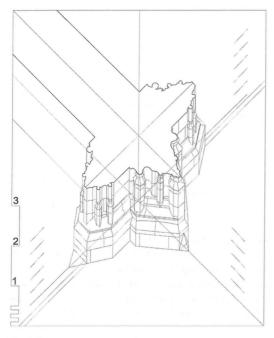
Axonometría del pilar entre capillas del lado norte. (Dibujo del autor)
